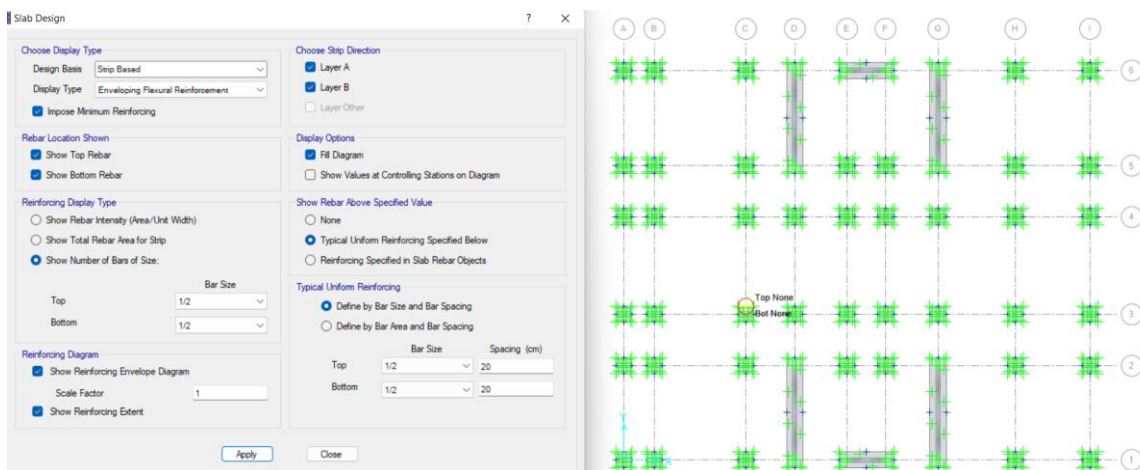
Área de acero requerida en zapatas 2da iteración. SAFE V.2016.
